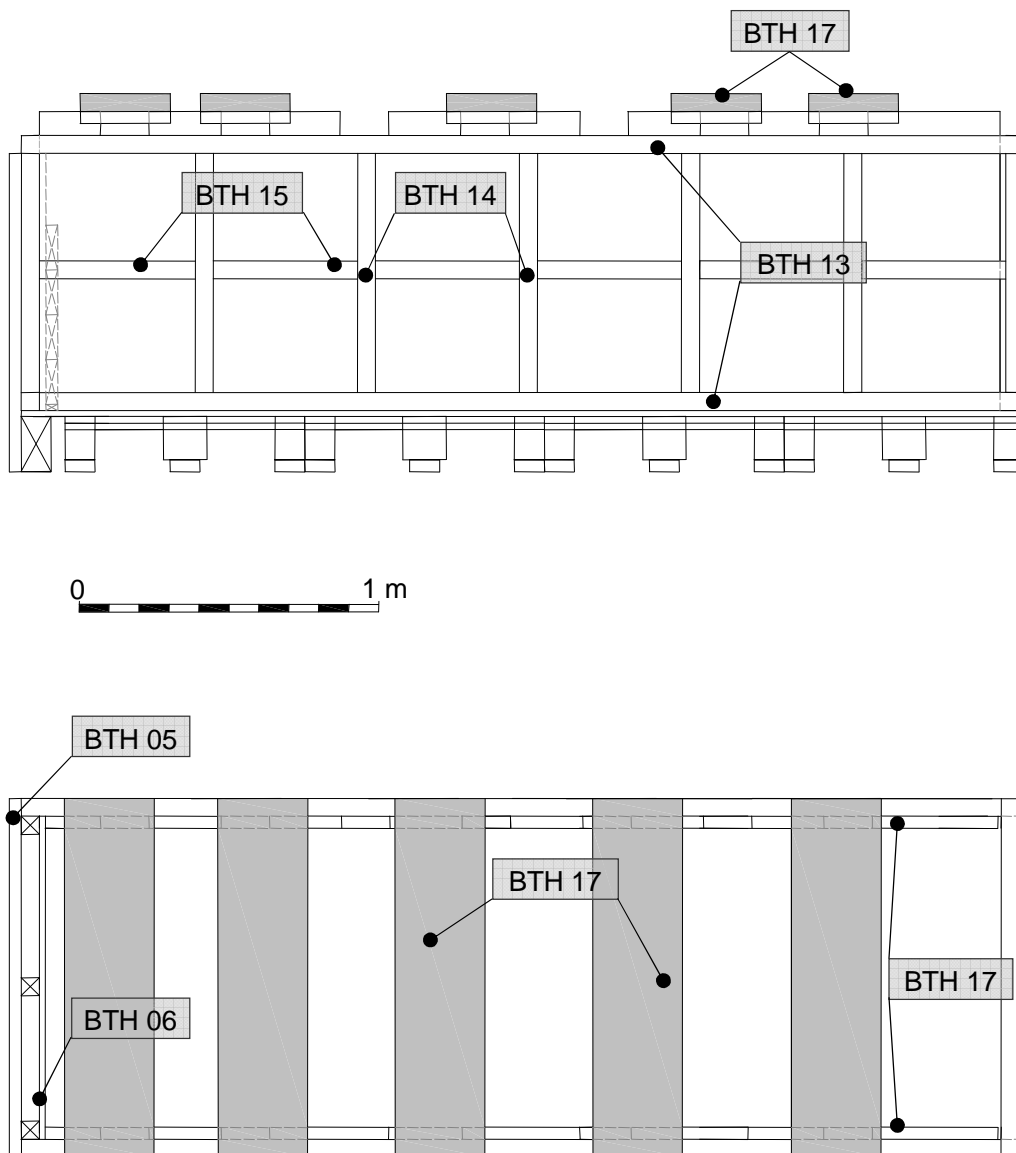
2 Seitenansicht und Draufsicht der Holzkonstruktion
